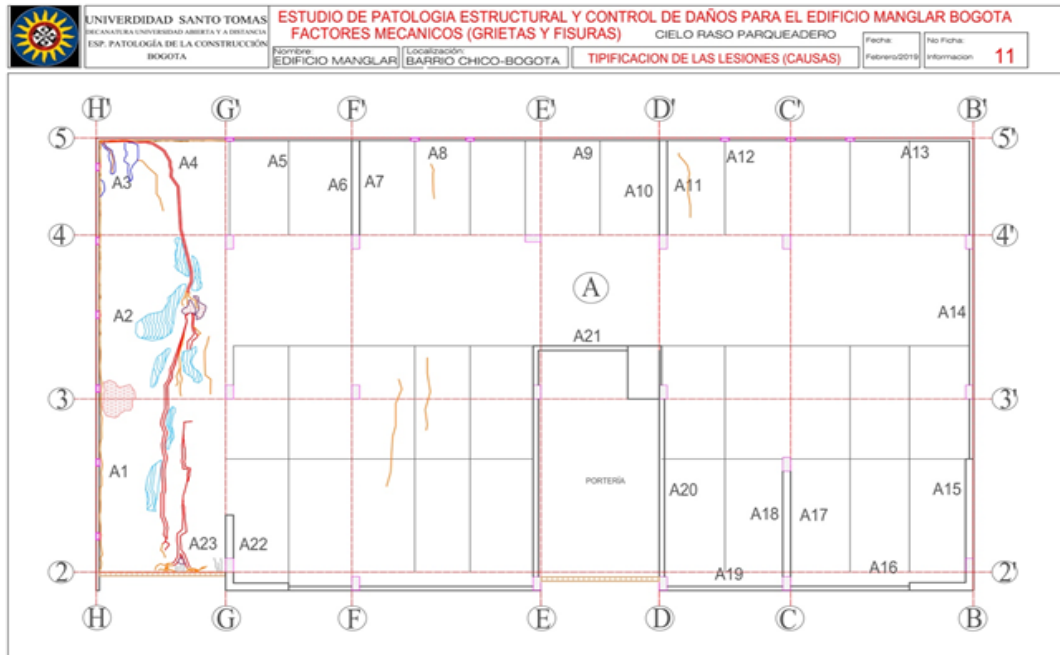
Planta Registro de Daños Placa Vista Superior Zona de Parqueo. Fuente: Elaboración propia
